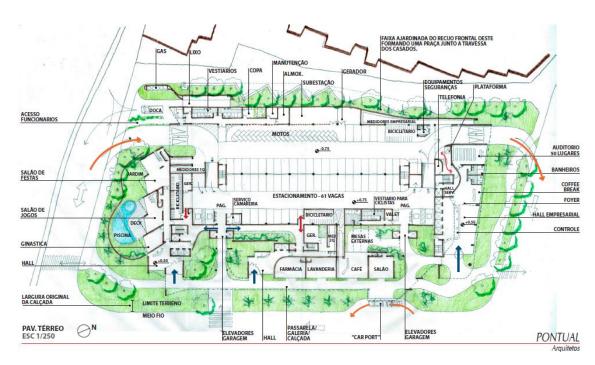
Planta Baixa pavimento térreo da nova proposta. Fonte: Autor do Projeto
